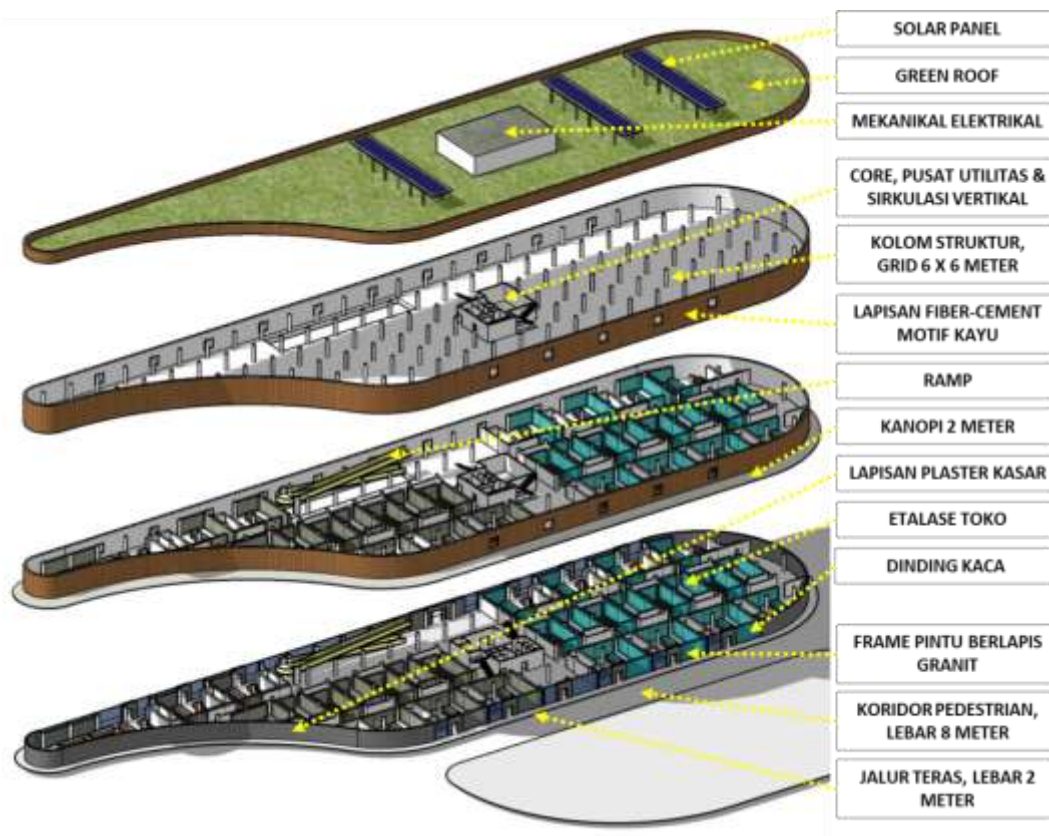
7 Aspek Walkability dalam Konsep Detail Bangunan
